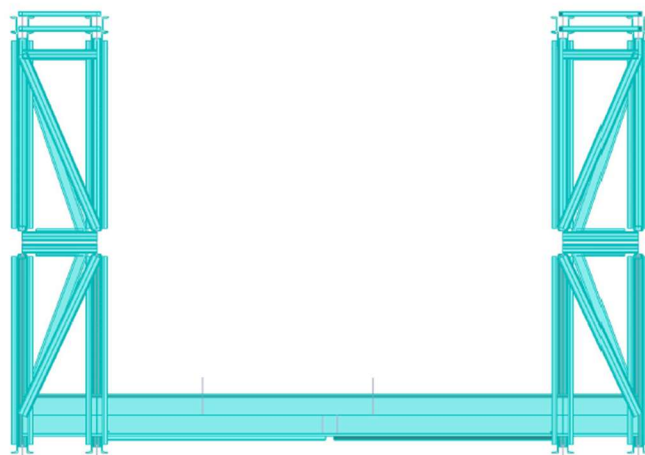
Alçado frontal da ponte de 54 m e uma faixa de rodagem
